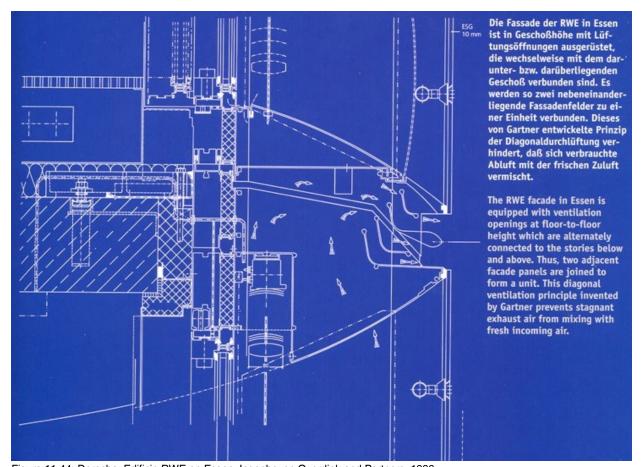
Derecha: Edificio RWE en Essen, Ingenhoven Overdiek and Partners, 1996; arriba: detalle de fachada.
